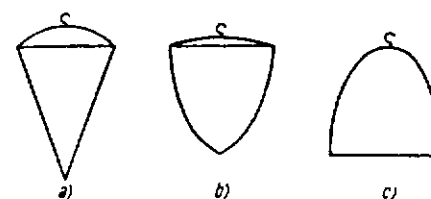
Piese metalice folosite la executarea piloților turnați :
